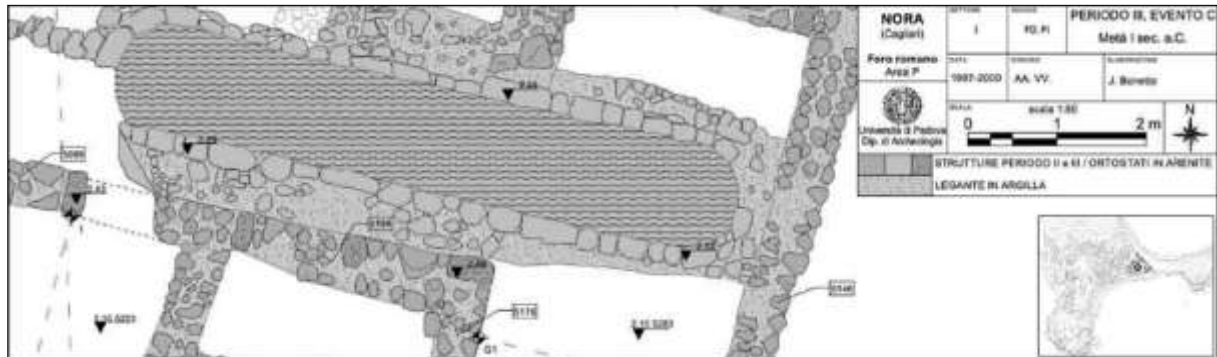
Pianta della cisterna 2 (rielaborazione da BONETTO 2009).
